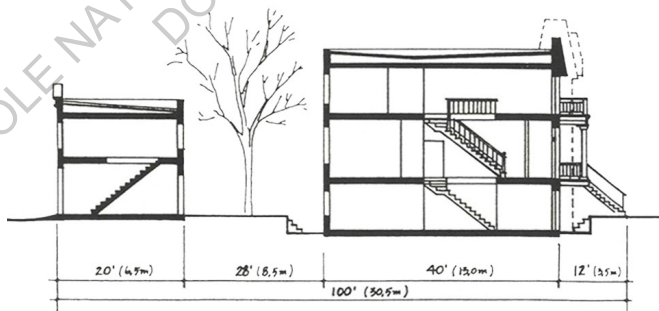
Plans, coupe et élévation d'une maisonnette de ville, rue Cherrier
